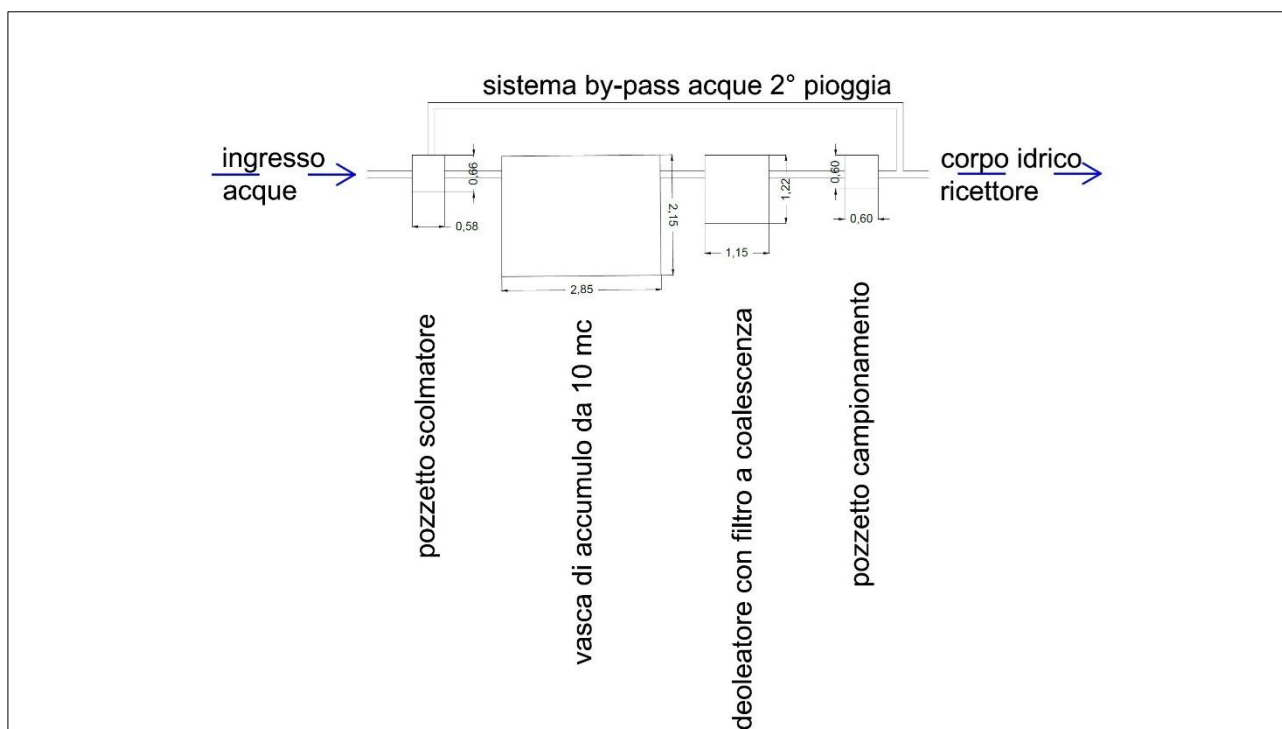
Sezione tipo dell'impianto di prima pioggia.
